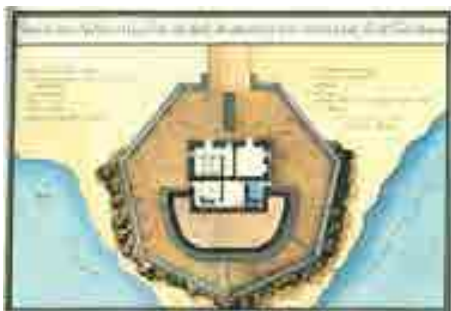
, *Pianta del nuovo ridotto con casa forte alle spalle, che attualmente si v'è costruendo sulla foce del fiume Ombrone, OXF*i*, Collezione delle piante, e prospetti delle fortificazioni situate lungo il litorale toscano che si conosce volgarmente sotto la denominazione di litorale grossetano per quanto si estende trà il confine dei Regj Presidj di Napoli, e l'altro del Principato di Piombino, c.n.n. (Pietro Conti, 1795).
